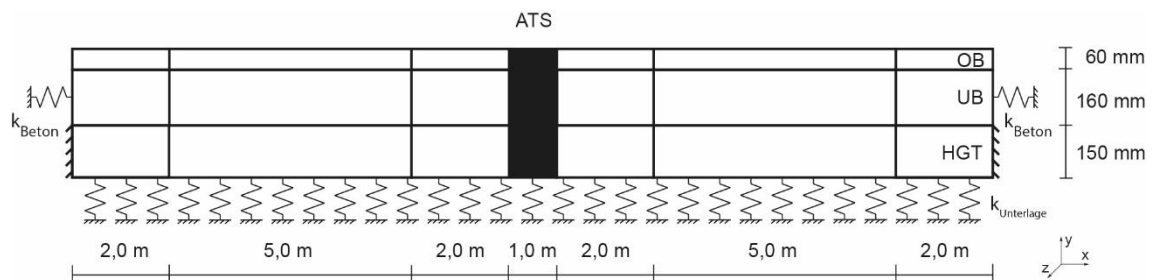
Modellgeometrie mit ATS-Streifen – Lagerung mit gelöstem Verbund zwischen Beton und HGT
